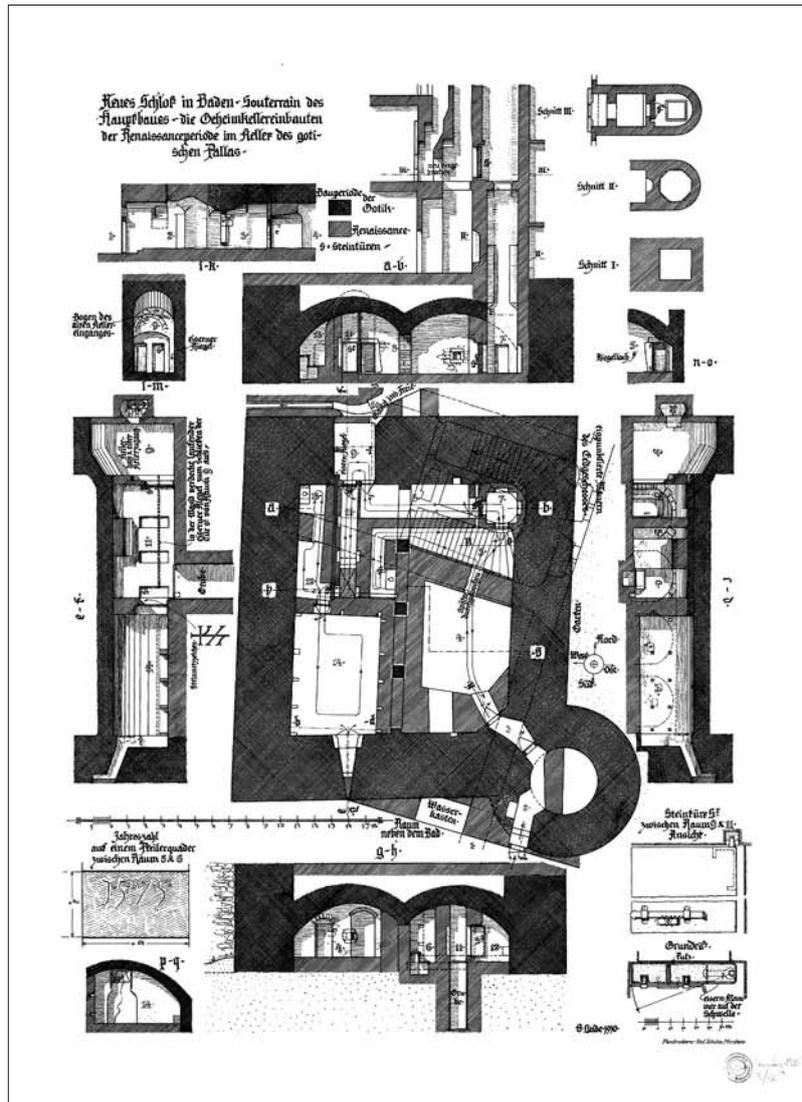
Hauptgebäude, nördlicher Keller, Grundriss, Schnitte und Details.
